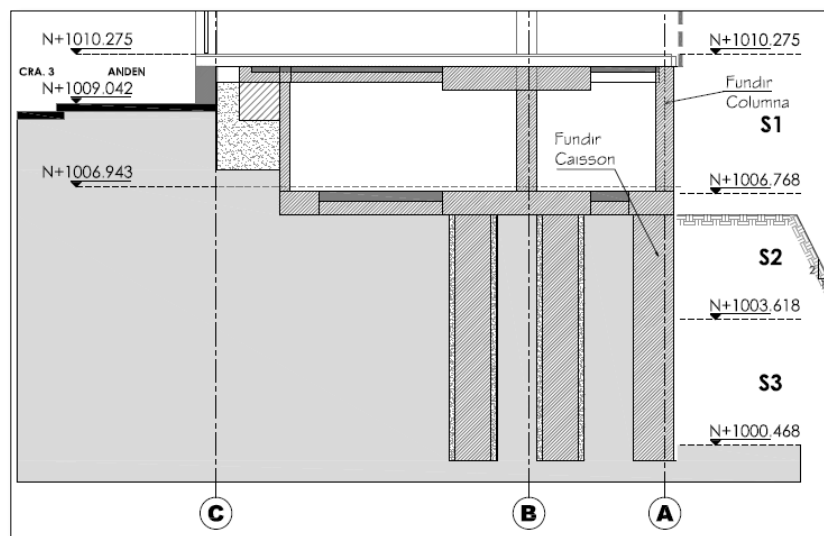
Sección Paso 6 - Alternativa 4 – Cimentación eje A.
